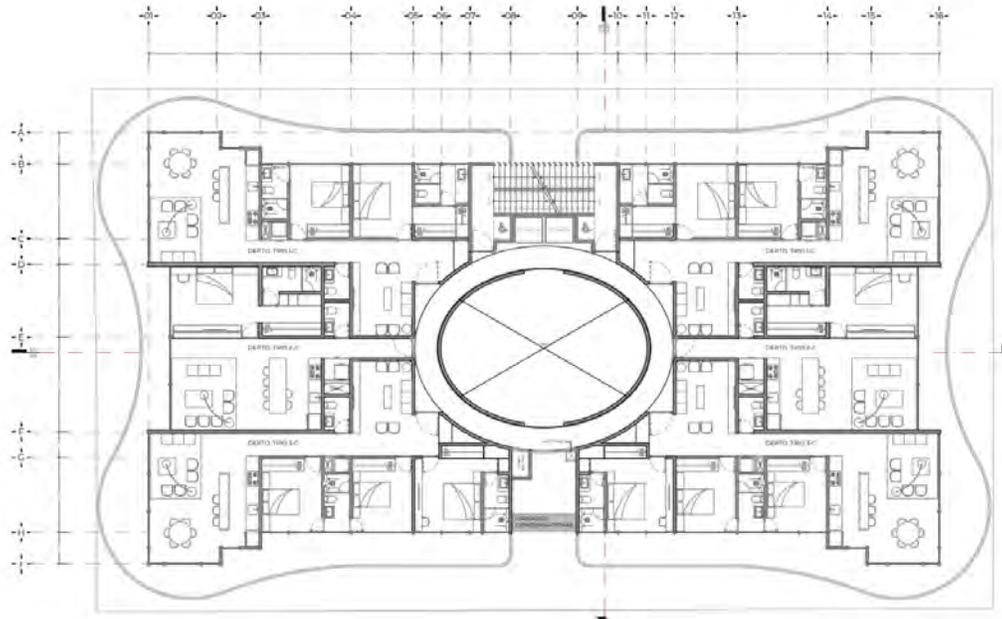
Plano del diseño del 8vo al 11vo nivel departamentos tipo C IKonic Tower.
